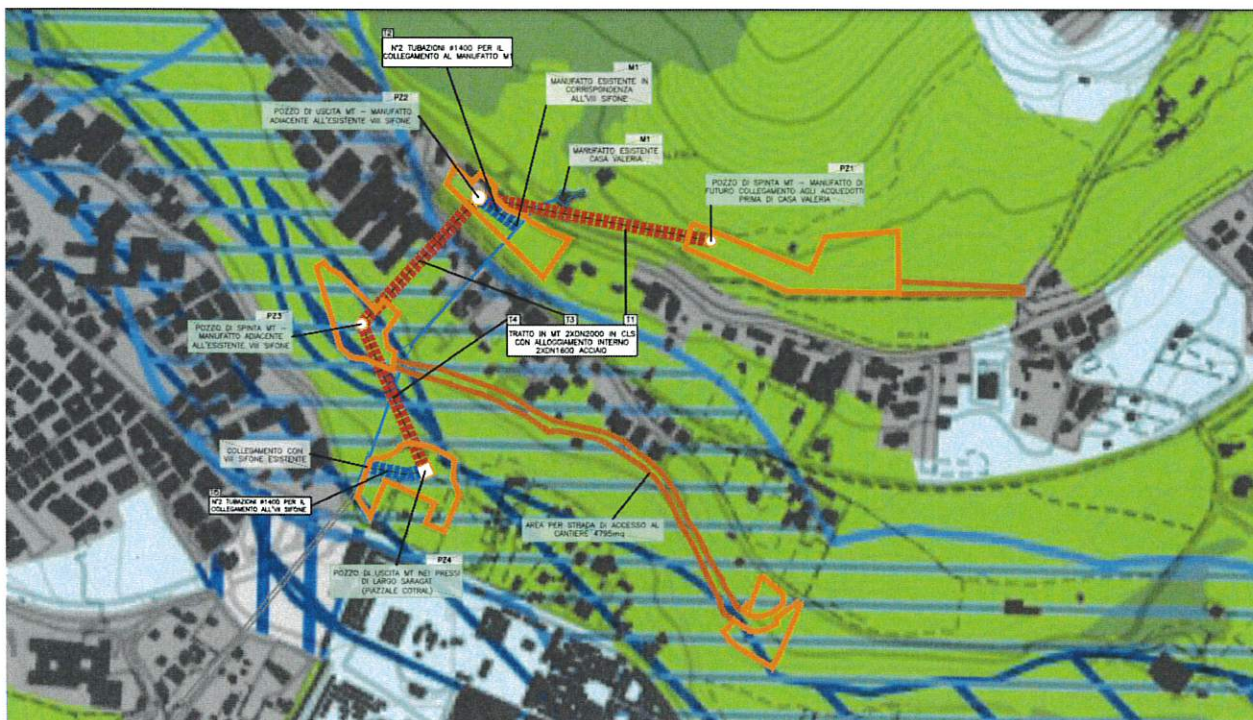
stralcio della sovrapposizione del tracciato di progetto (di progetto e delle aree e piste di cantiere con la Tav.A del PTPR
